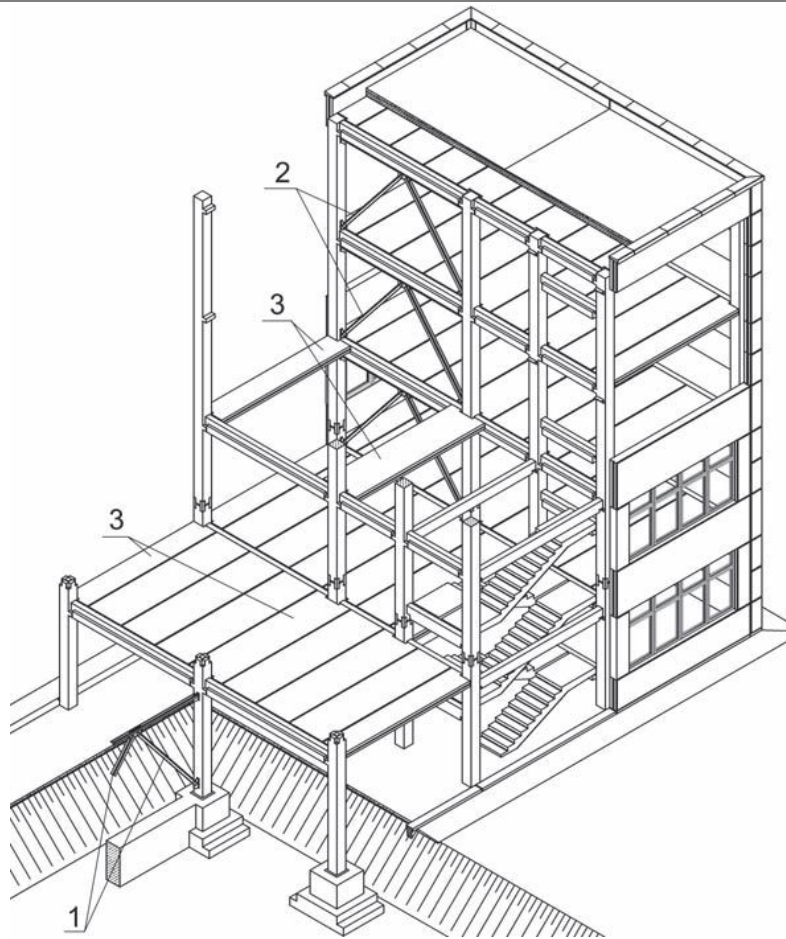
Многоэтажное здание связевой конструктивной схемы (серия 1.020.1): 1 — стальные связи на всех этажах здания в продольном направлении; 2 — стальные связи на всех этажах здания в поперечном направлении; 3 - плиты-распорки, установленные по осям колонн в продольном направлении
